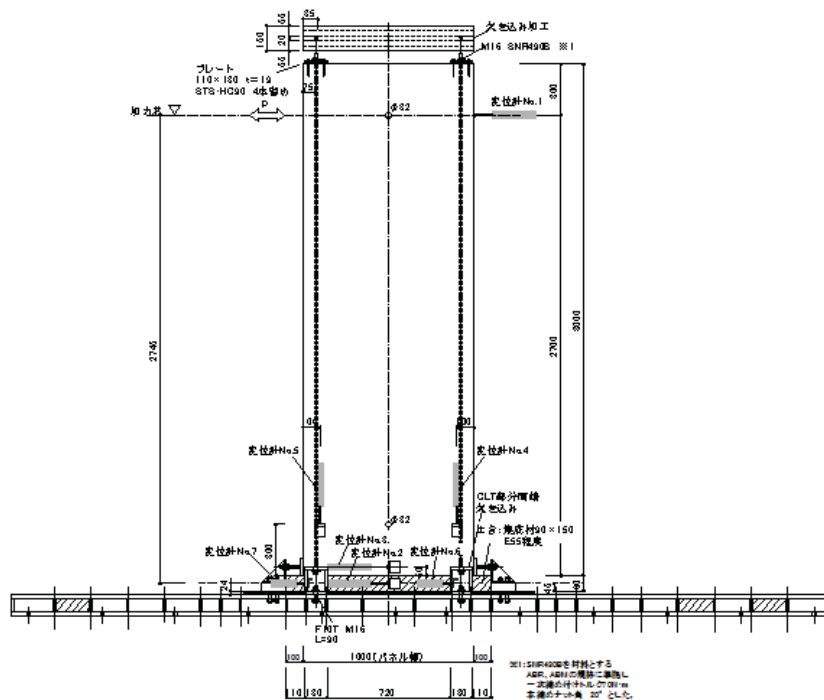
タイロッド（1m幅耐力壁）試験体立面図(TR1-1)
